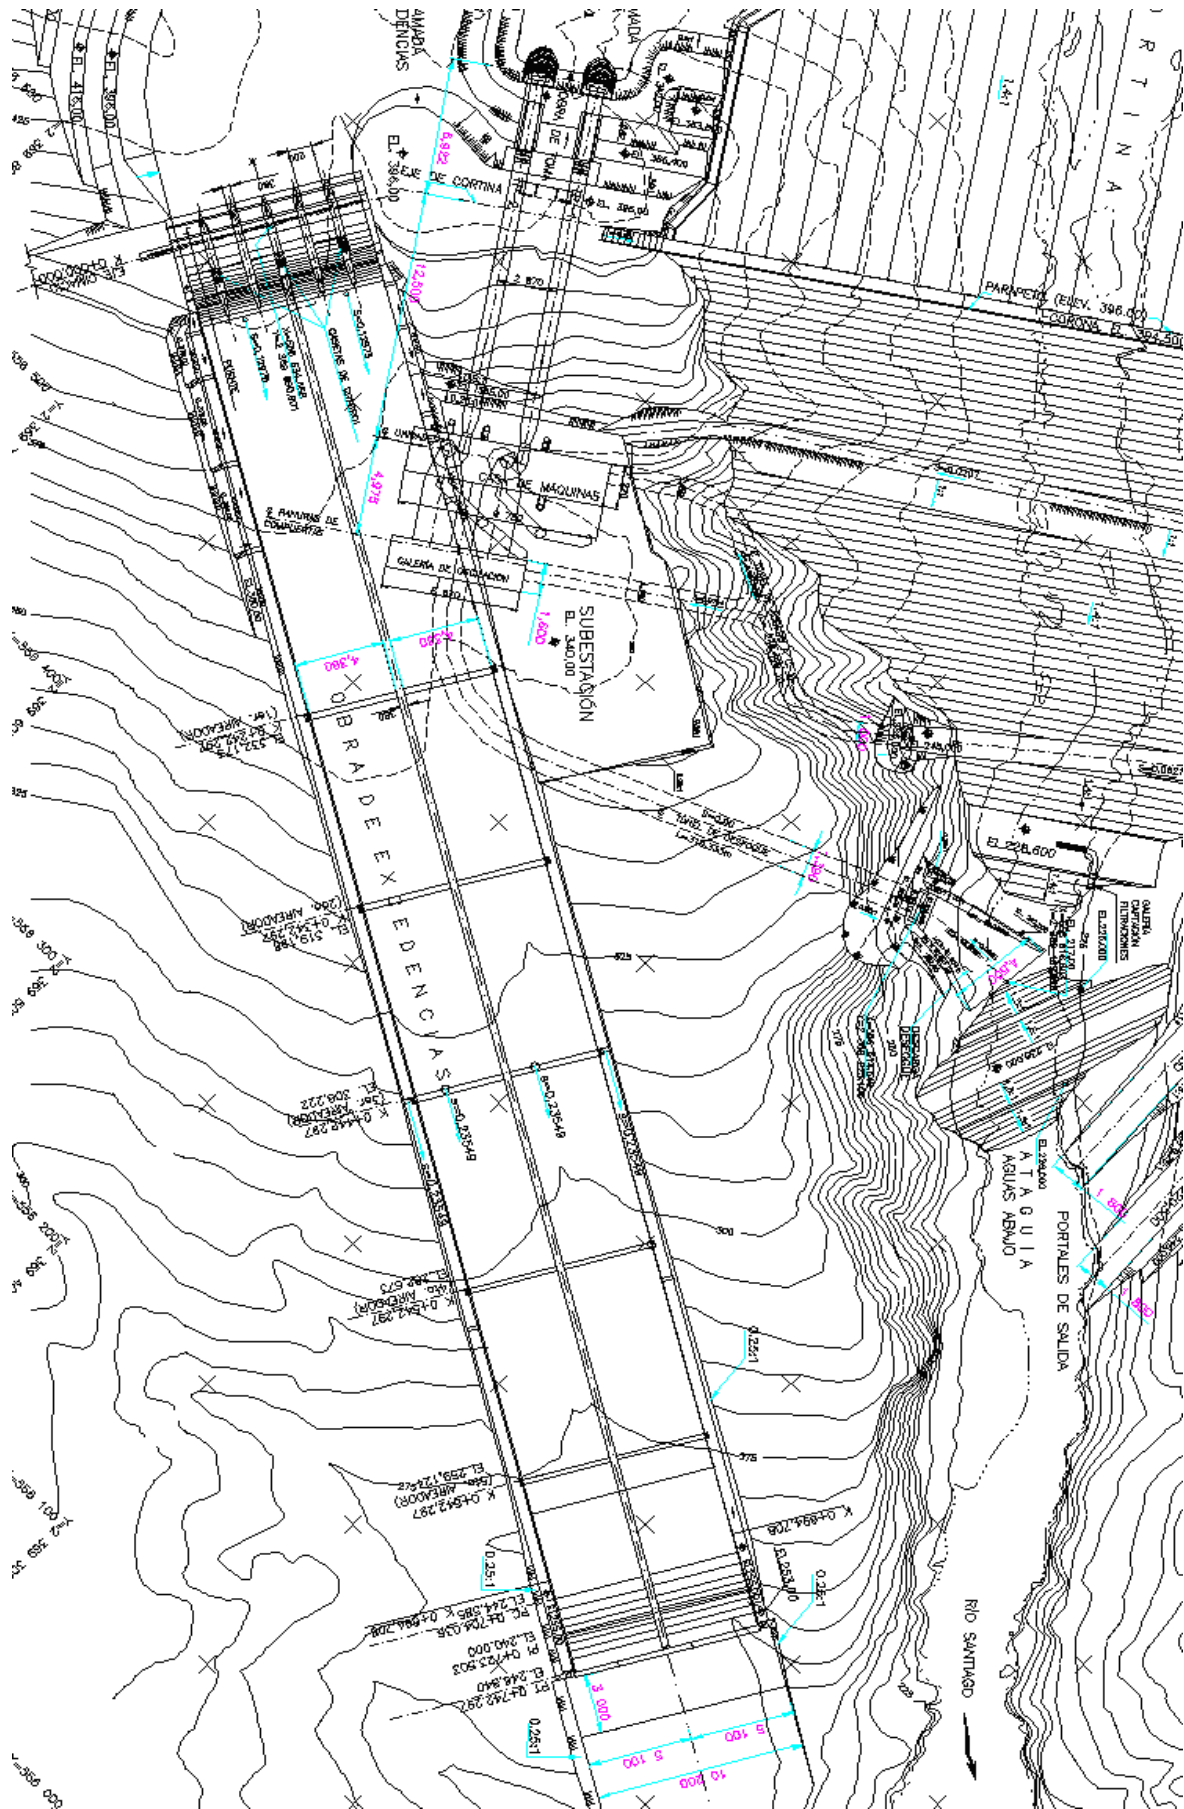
Planta general de la obra de excedencias del P.H. El Cajón.
